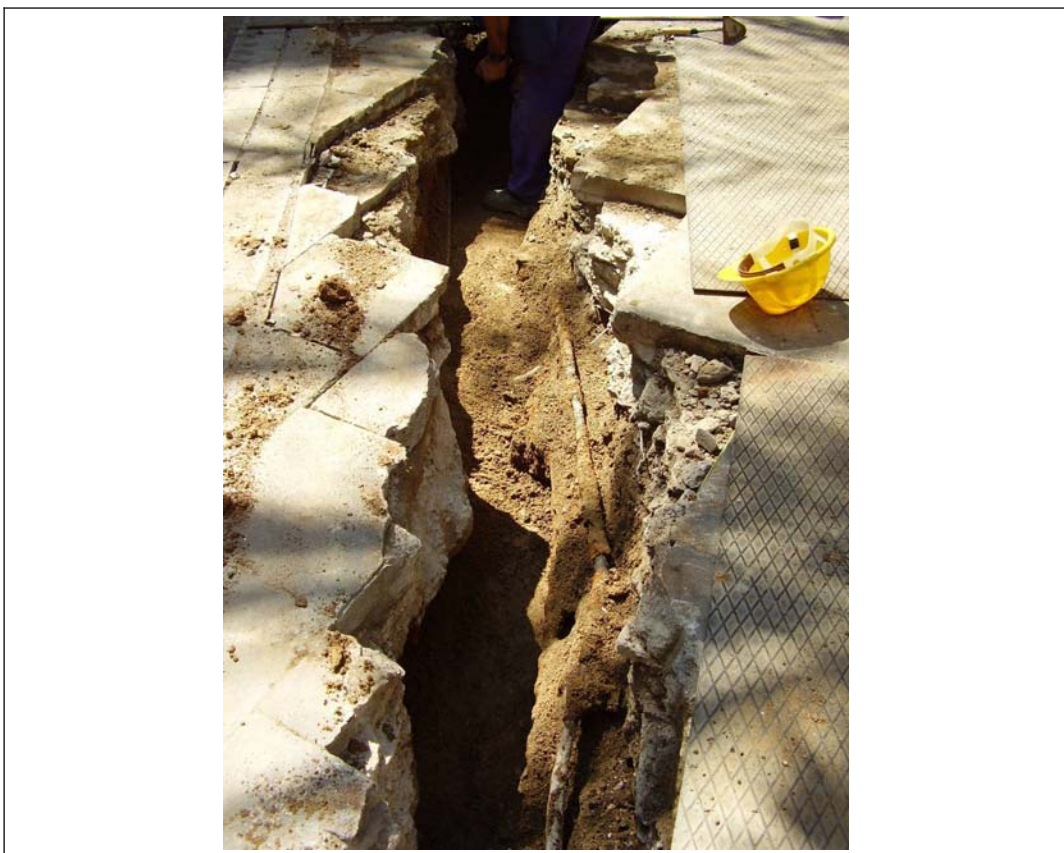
Tram del carrer Tallers en direcció al carrer Ramelleres
